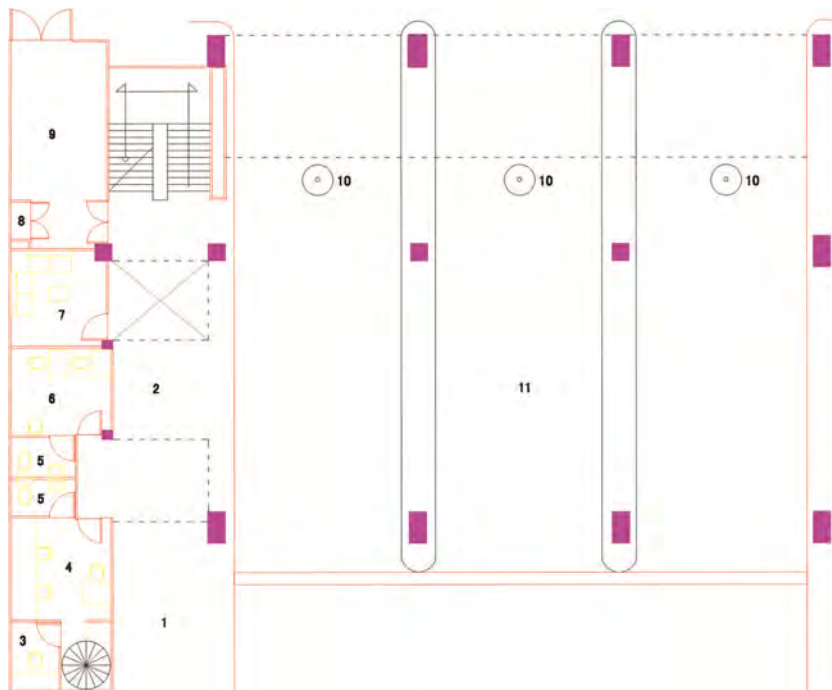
PLANTA BAJA ARQUITECTONICA, CENTRAL DE BOMBEROS IZTAPALAPA.
